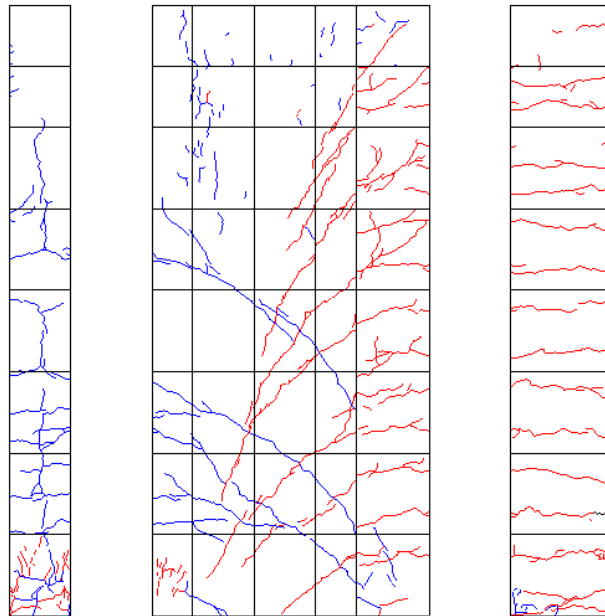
R=1/50 ひび割れ図
